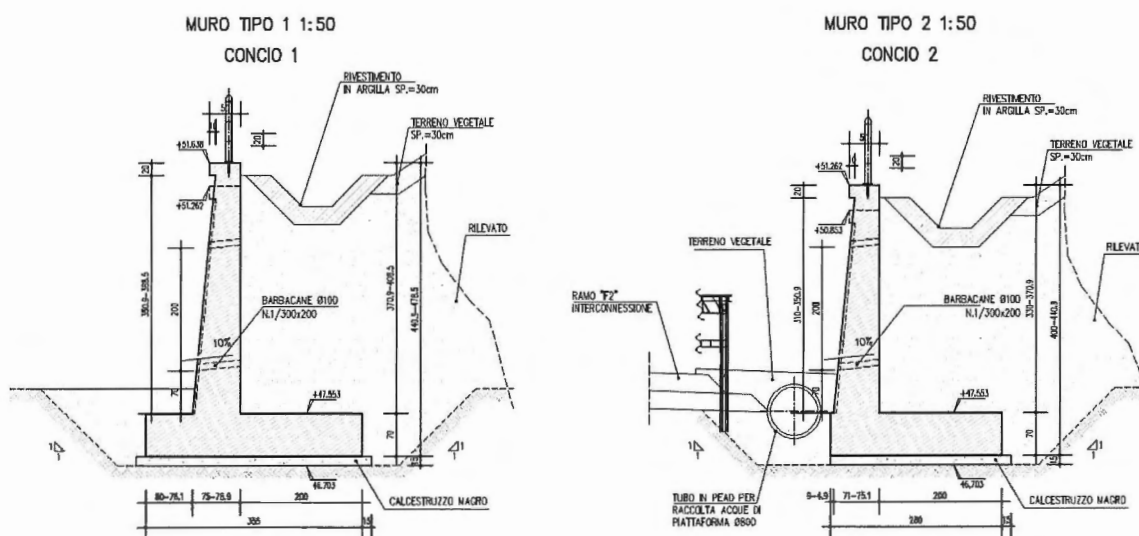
Sezione Tipo - Muro 1 e 2
